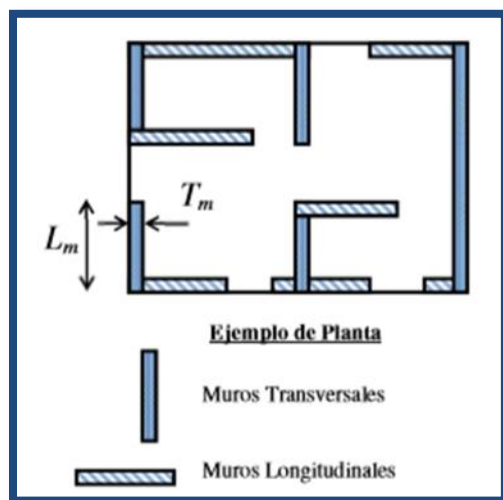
Muros transversales y longitudinales configuración en planta para calculo de porcentajes de muros. Fuente: Buildchange and Swisscontact, 2015
